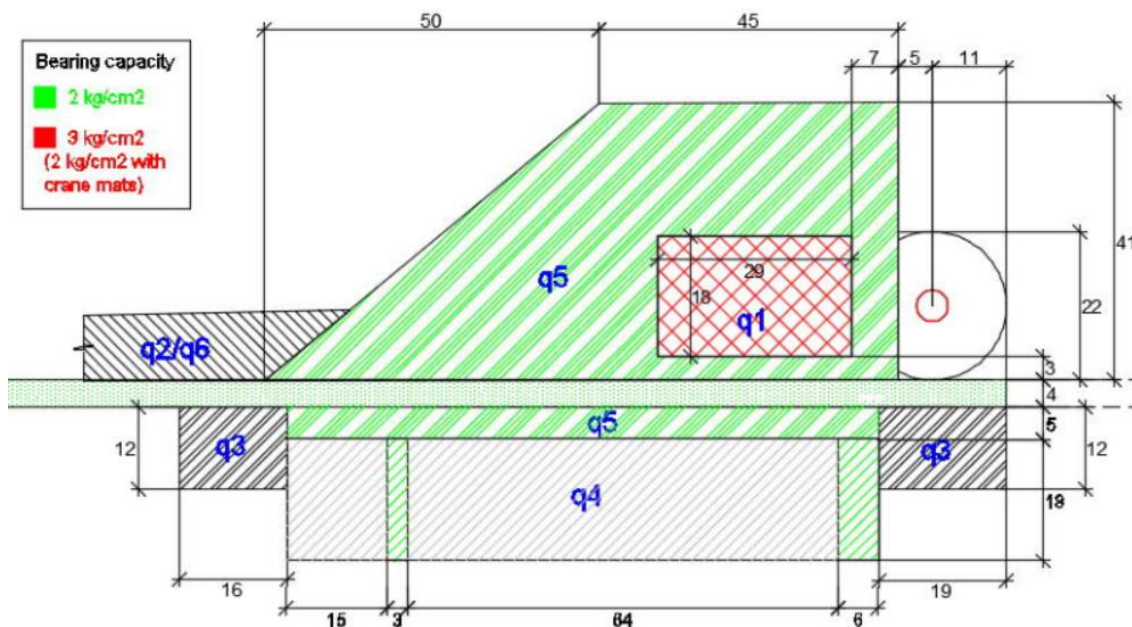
Plataforma de montaje y zonas de acopio para torre de 115 m.
